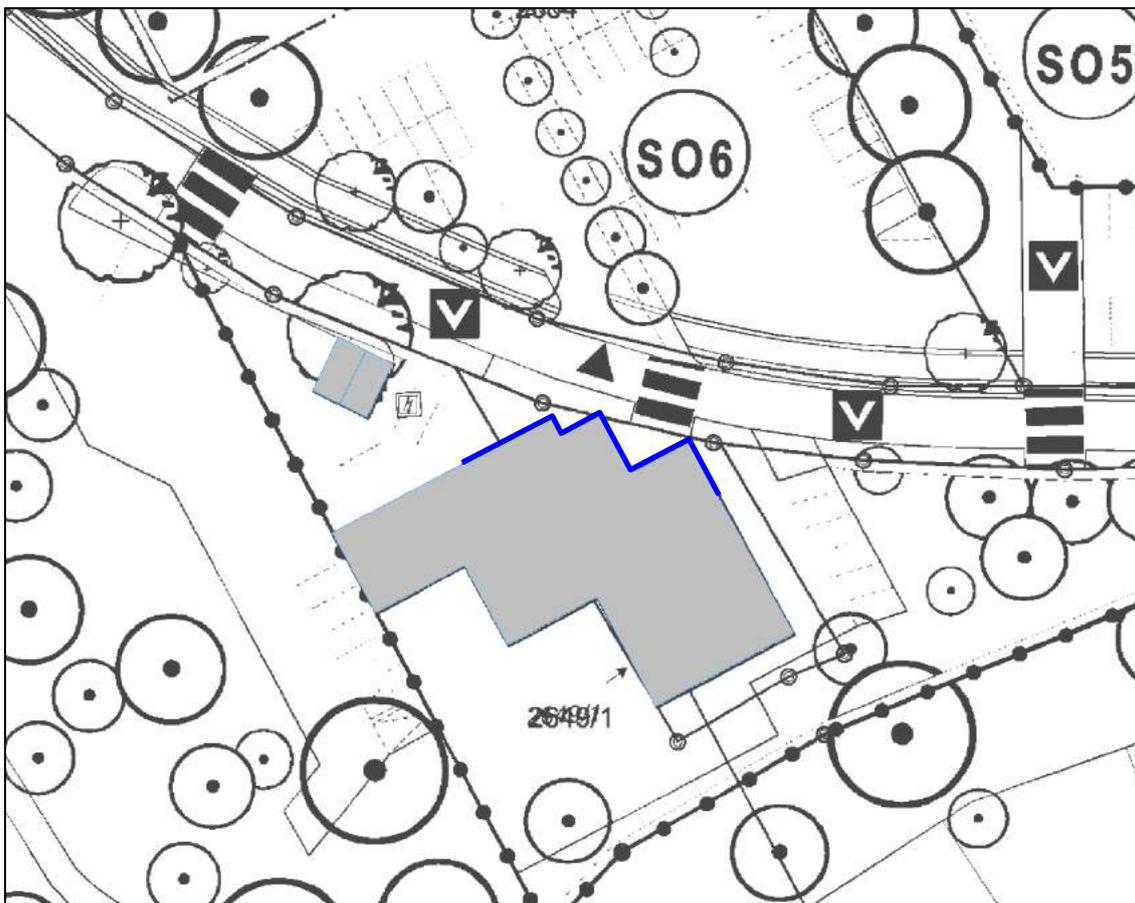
Darstellung der Fassadenbereiche mit Empfehlung für passive Schallschutzmaßnahmen bei Neu- und Ersatzbauten
